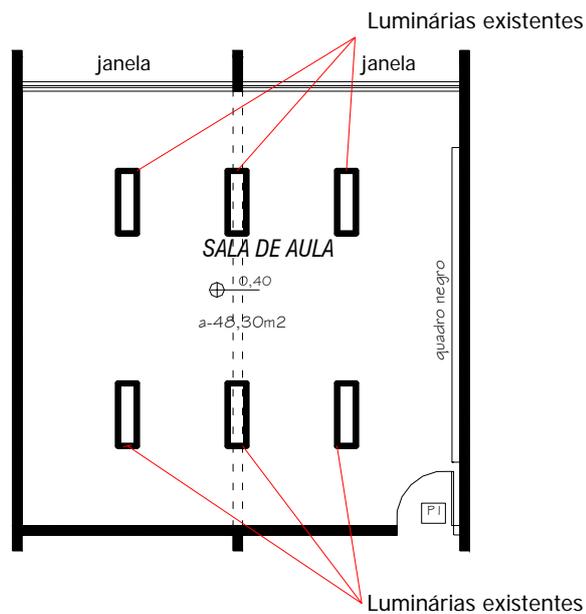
Planta baixa com localização das luminárias de teto existentes.
